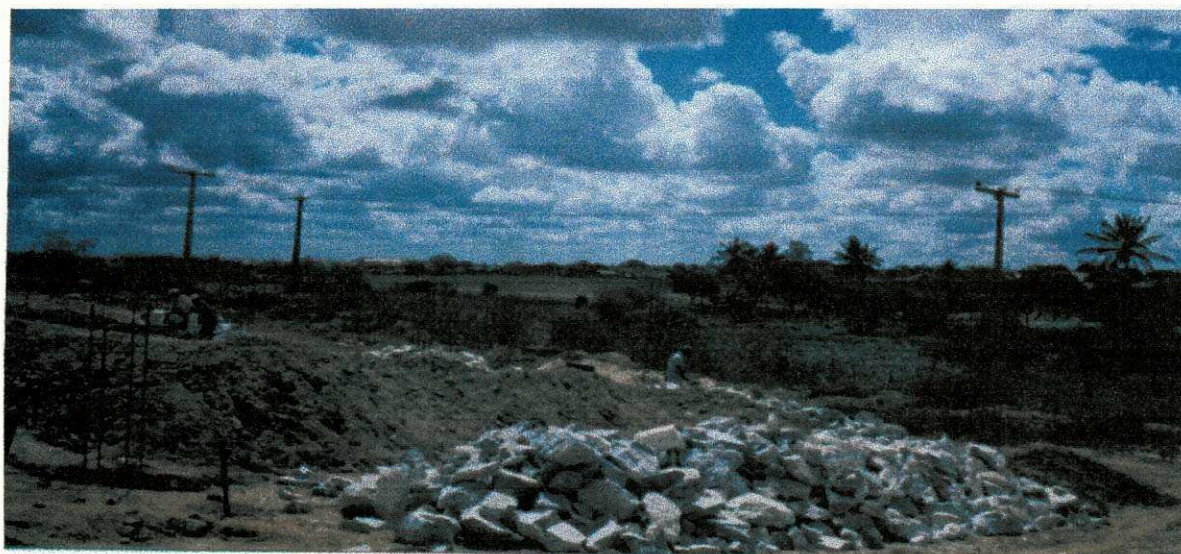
EXECUÇÃO DO MURO DE ARRIMO
